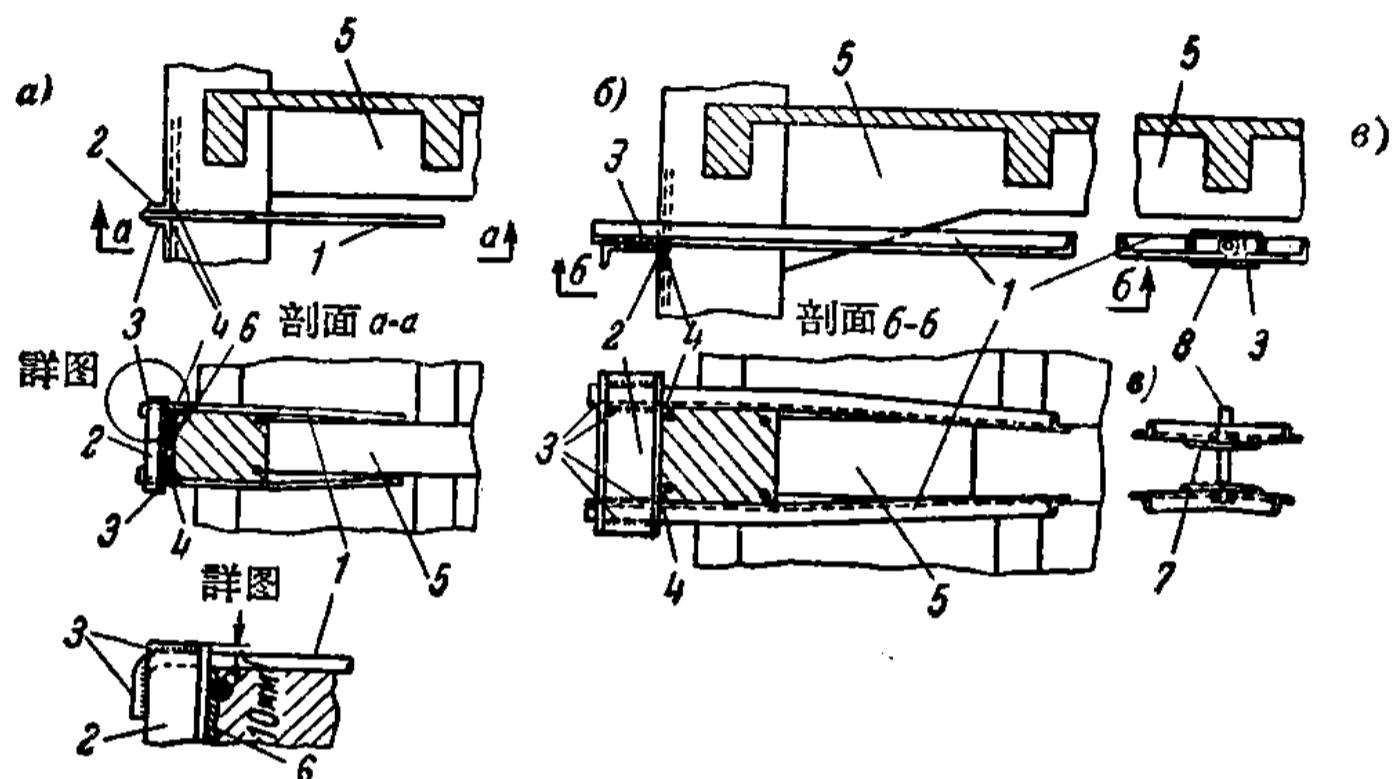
以柱子作为钢筋混凝土构件的支座时，柱上水平
